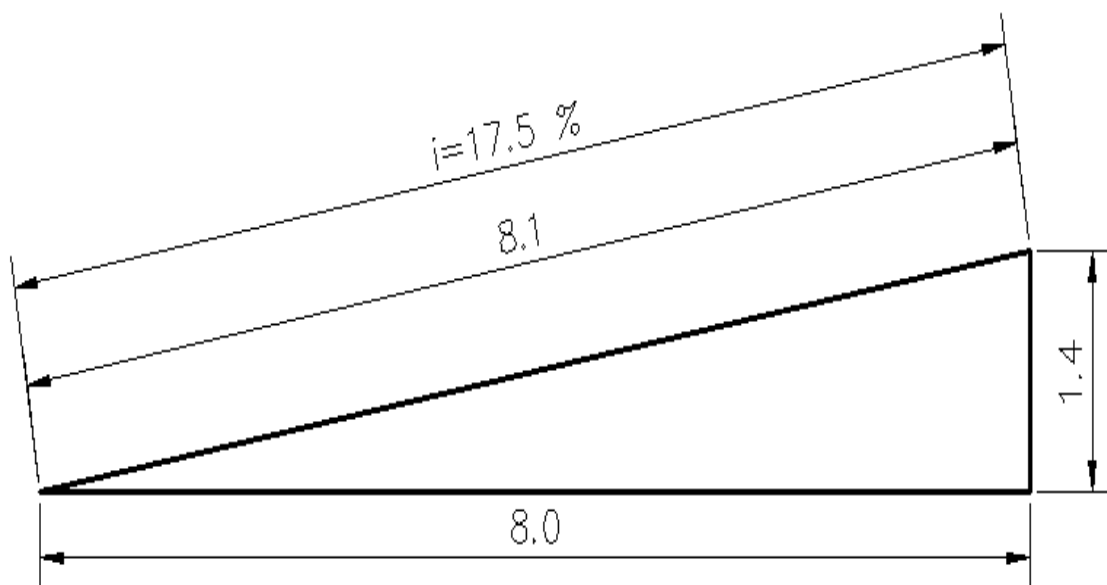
Pjesa hyrëse e rampes dimensionet.
